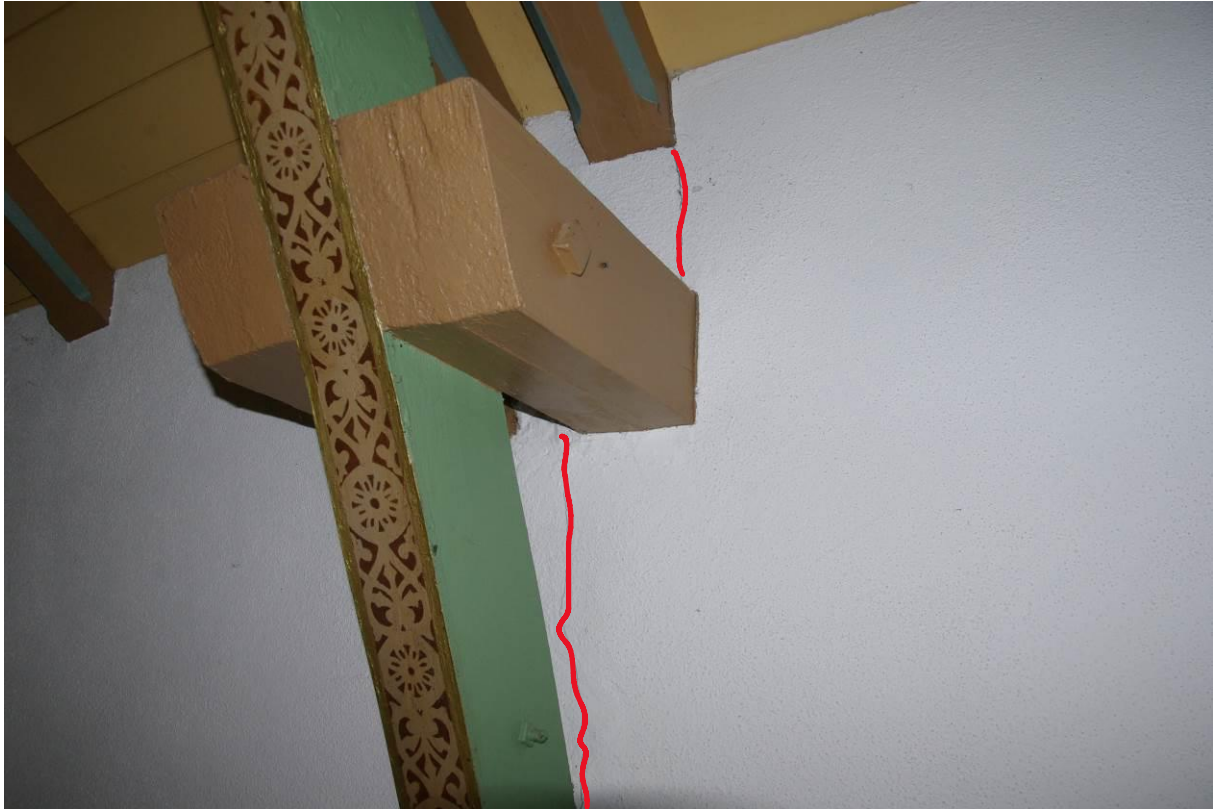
Wandanschluss der Bogenkonstruktion, Mauerwerksrisse.
